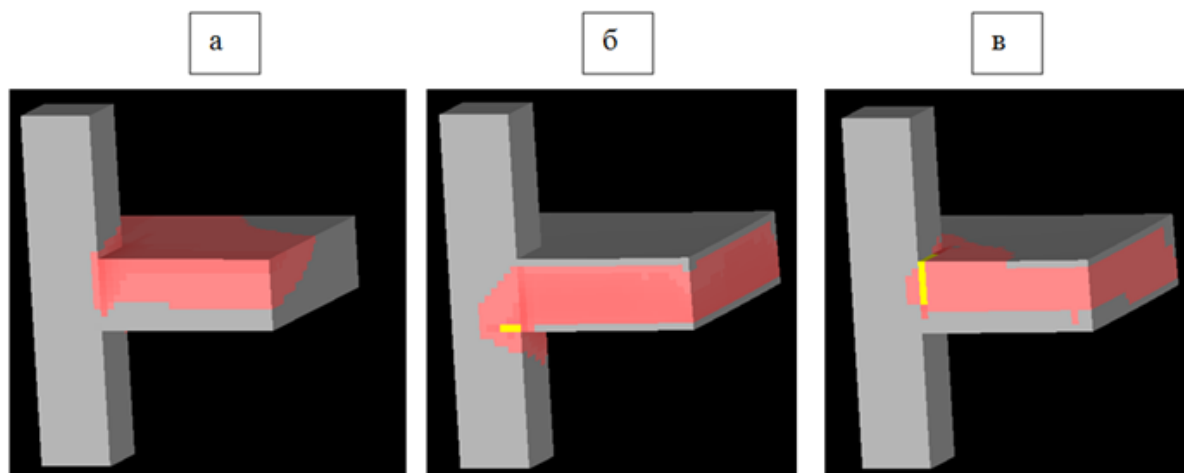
Картины разрушения фрагментов узла соединения железобетонных плит с железобетонными колоннами по модели 2
